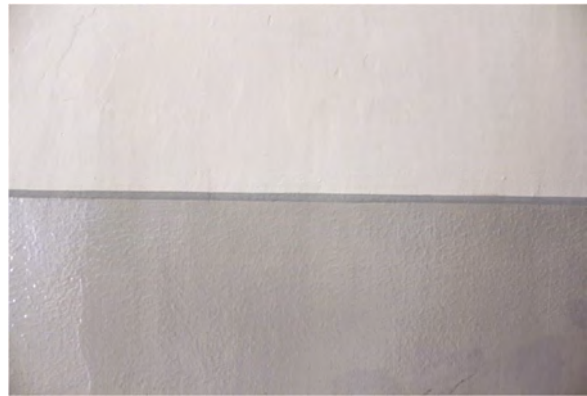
Raum 1.01, Wand c; Detail der Neugestaltung, weiße Wandfläche, grauer Sockel und dunkelgrauer Begleitstrich.
